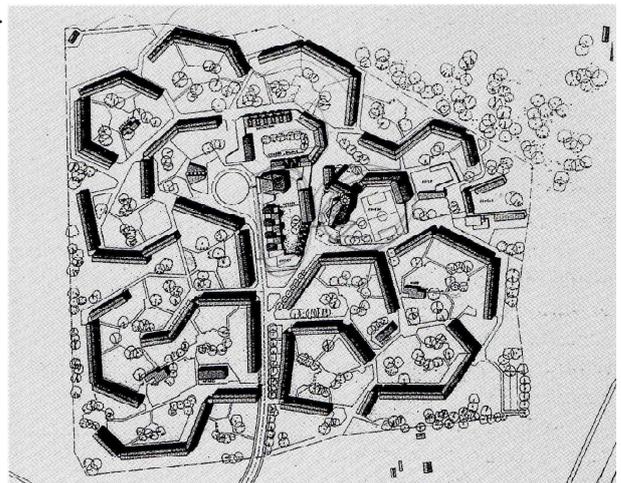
Planimetria generale del progetto definitivo, 1954
